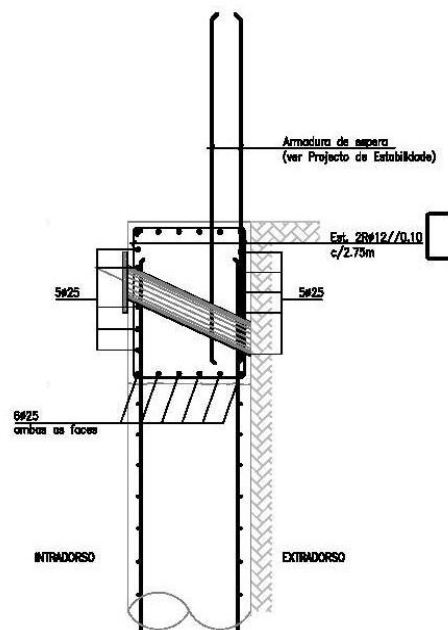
Pormenor de viga de coroamento (cortesia Geofix)
